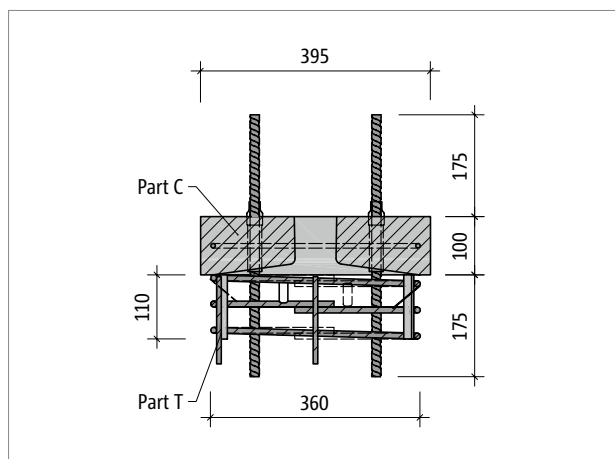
Schöck Sconnex® type P-B400: Aanzicht van bovenaf
